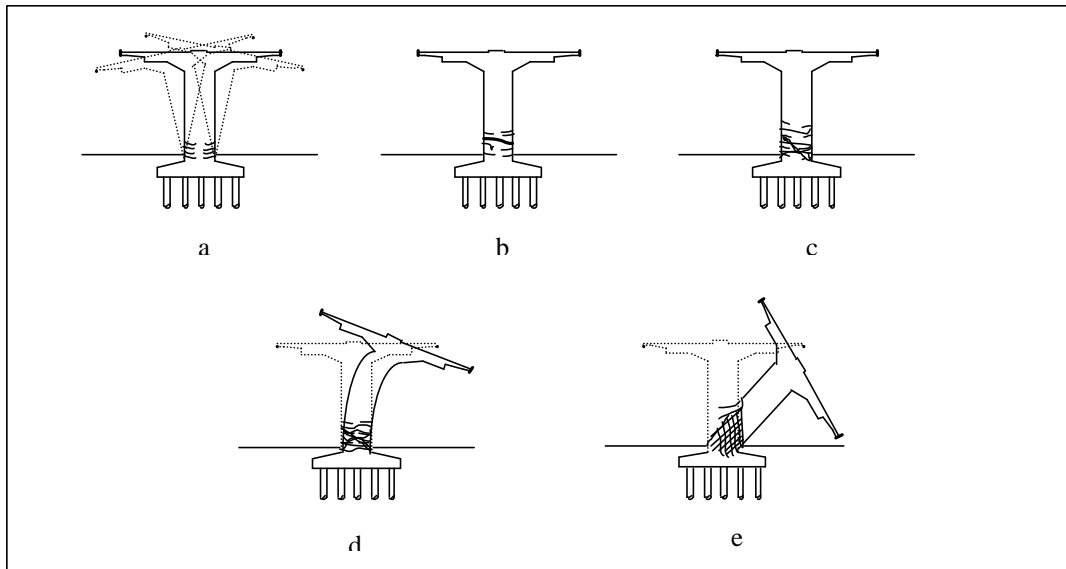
Representación esquemática del mecanismo de fallo de algunas porciones de la vía rápida de Hanshin: a) aparecen grietas por flexión en la sección crítica, b) agrietamiento de toda la sección, c) cambio de agrietamiento por flexión a agrietamiento por cortante, d) desprendimiento de la cubierta de hormigón, colapso gradual por efectos P- δ , y e) estado final donde se observa la ruptura de las barras principales de refuerzo.
